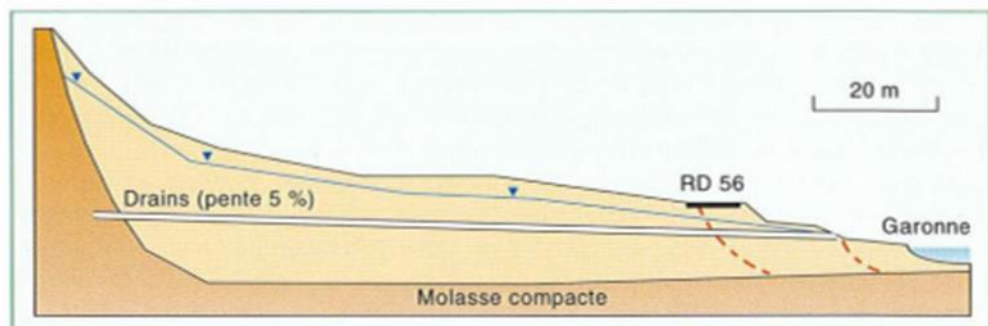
Stabilisation de la RD 56 à Muret par la technique de drains subhorizontaux. [IIIV]
